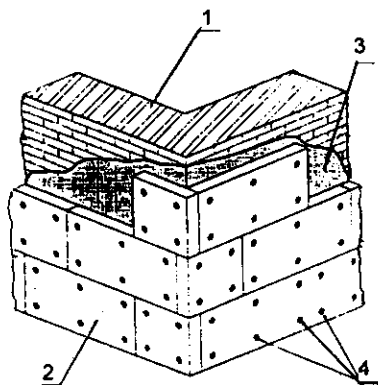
Система утепления стен с оштукатуриванием фасадов
